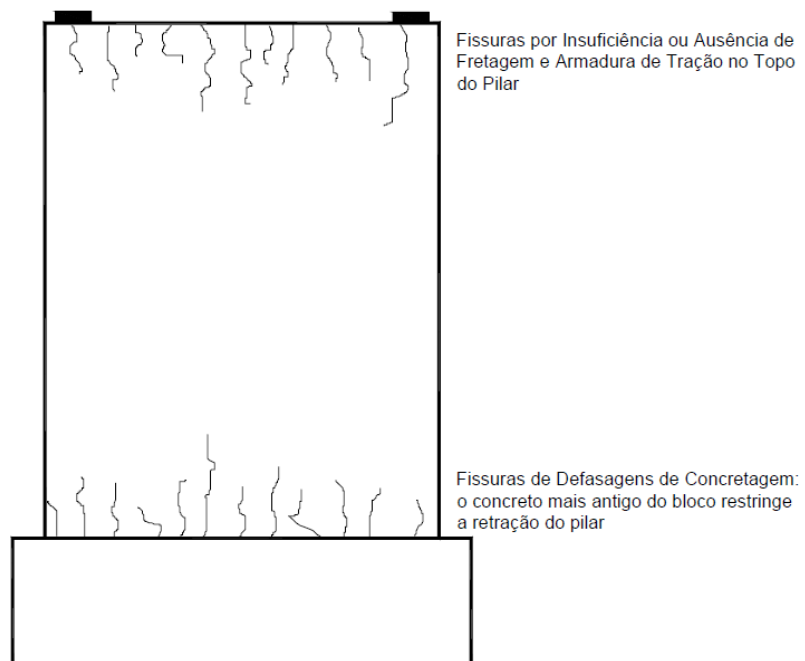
Seção longitudinal de Pilar Isolado: Fissuras por Deficiência de Fretagem
